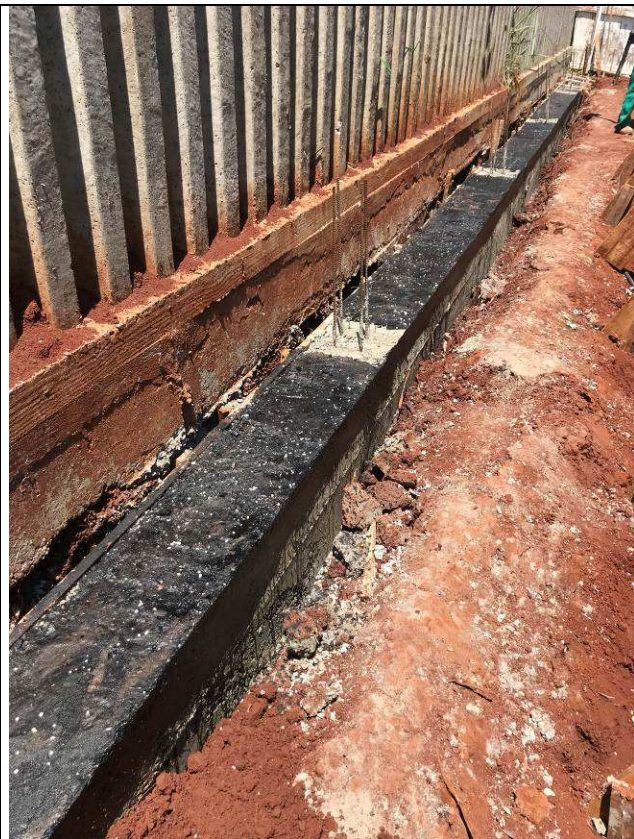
C: Vigas baldrame - muro de fechamento - fundos.
